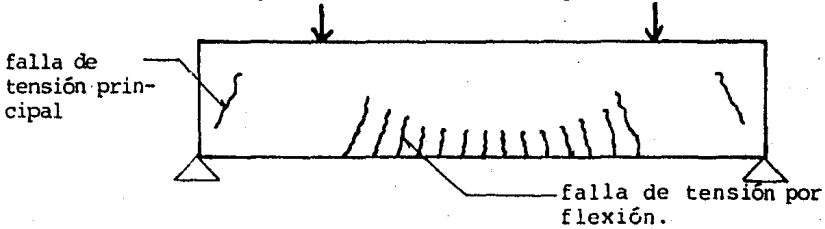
Diferentes tipos de fallas por cortante en vigas presforzadas.
